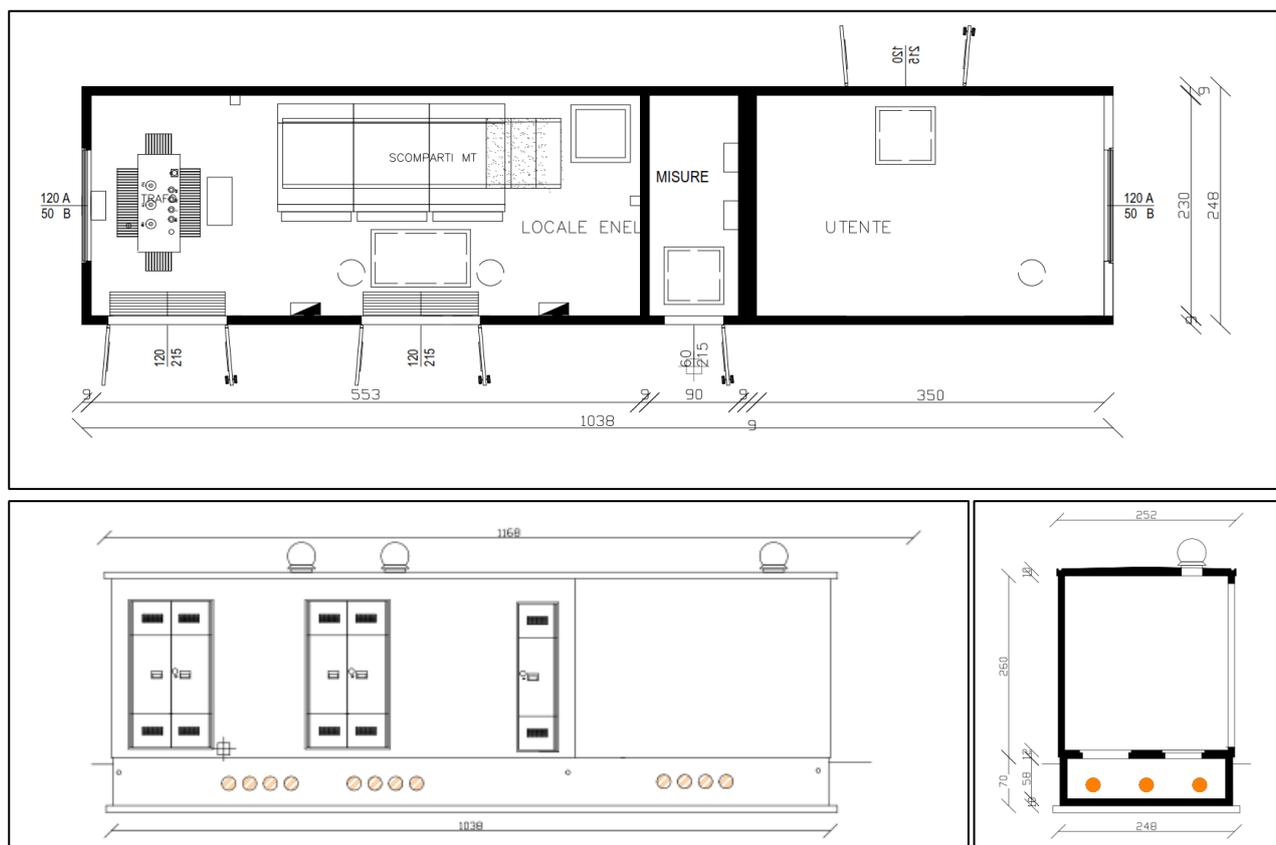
Vista in pianta/prospetto/sezione cabina di consegna.
